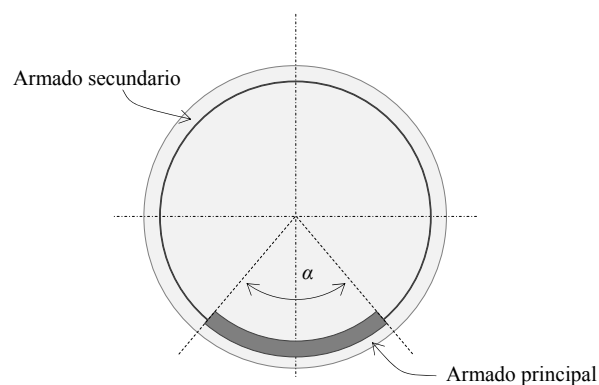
Sección transversal según Weber y Ernst [55]
